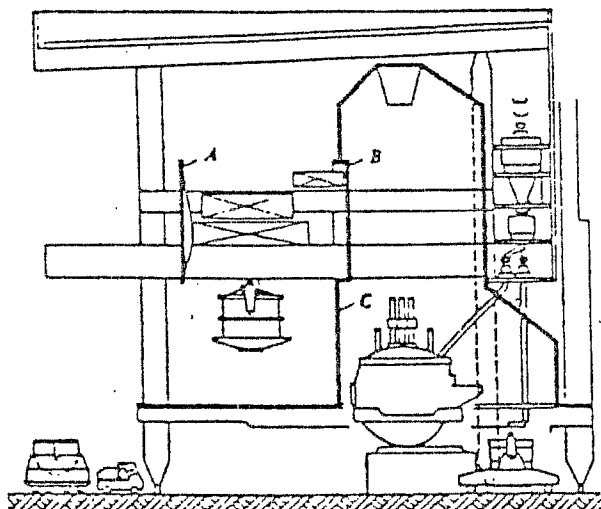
Sezione longitudinale di acciaiera elettrica con provvedimenti per l'insonorizzazione secondo il sistema Krupp.
